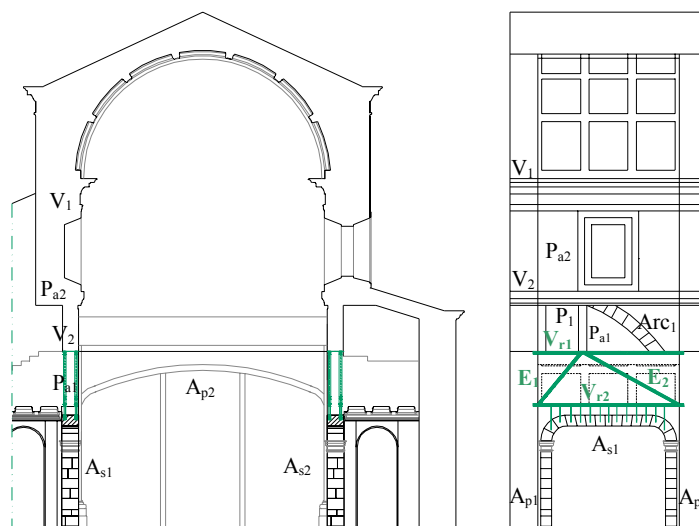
Estrutura de reforço do arco da Igreja do Pópulo – Alçado e corte
